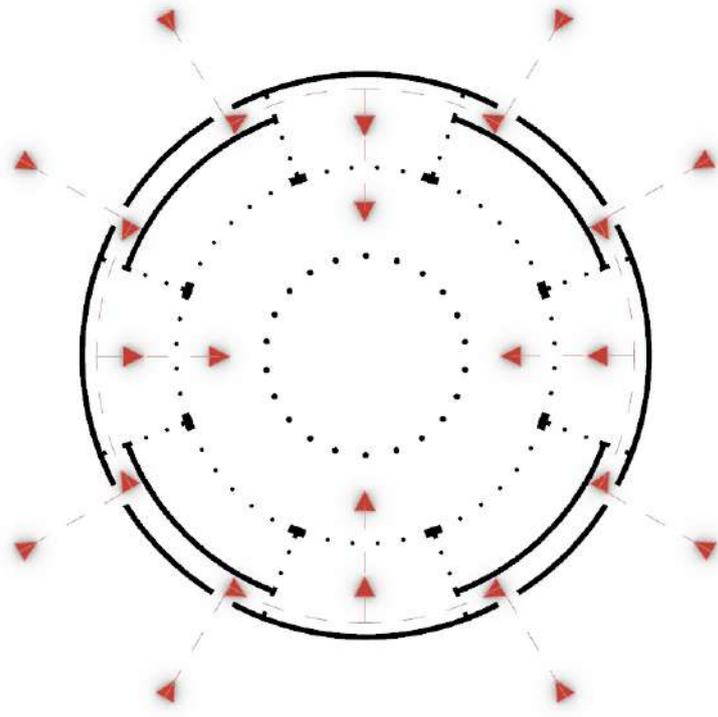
Santo Stefano Rotondo; Wegführung und Erschließung durch die 8 Eingänge des ursprünglichen Bauwerks
